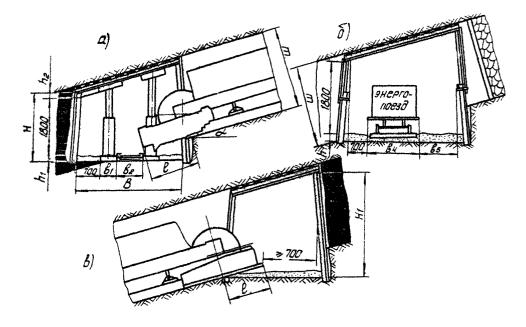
І. Расчетные схемы определения площади сечения выемочных выработок при безнишевой выемке угля в КМЗ: а - для конвейерного штрека; б, в для вентиляционного
